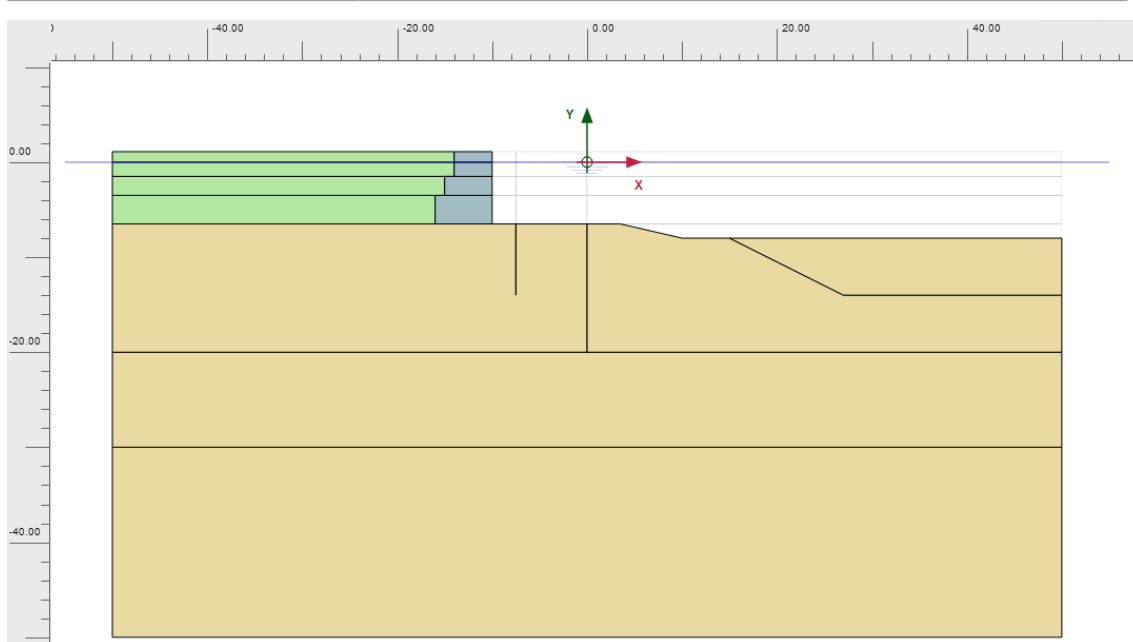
Fase 2 – Condizione ante operam - Riempimento in tout-venant a tergo del muro di sponda
